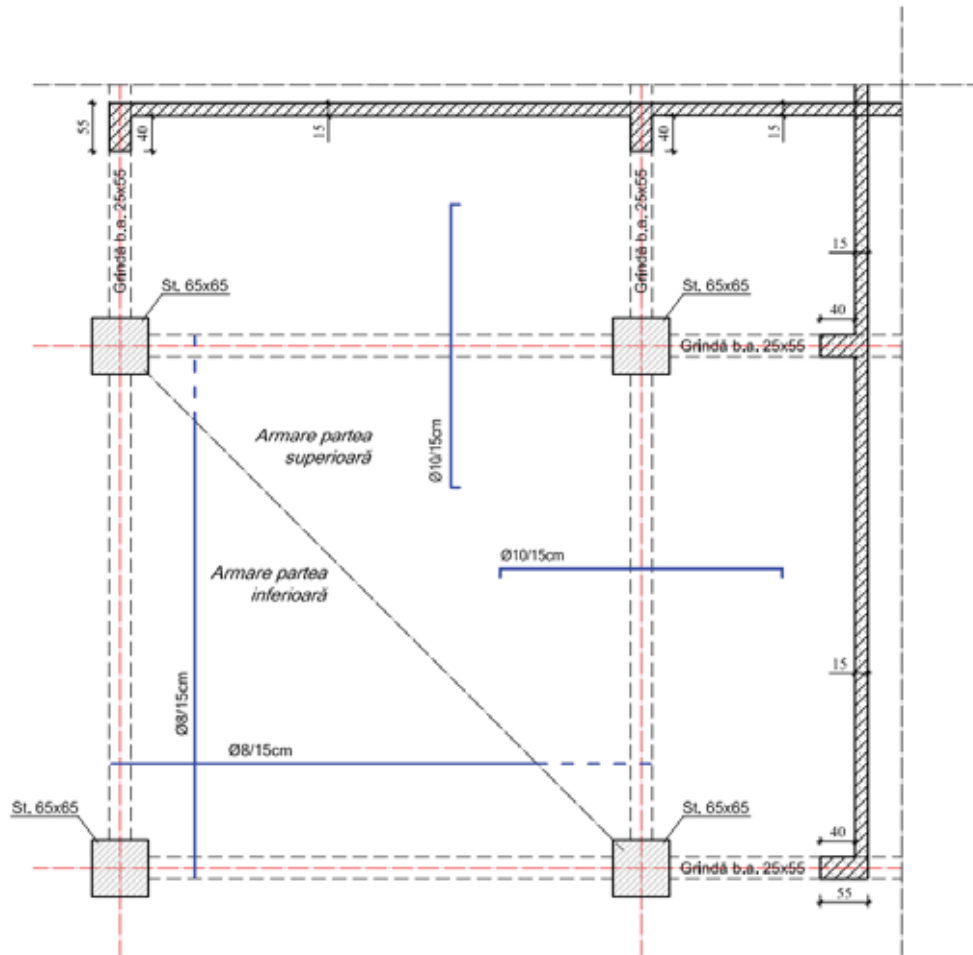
Structură P+8E: plan armare placă b.a.
